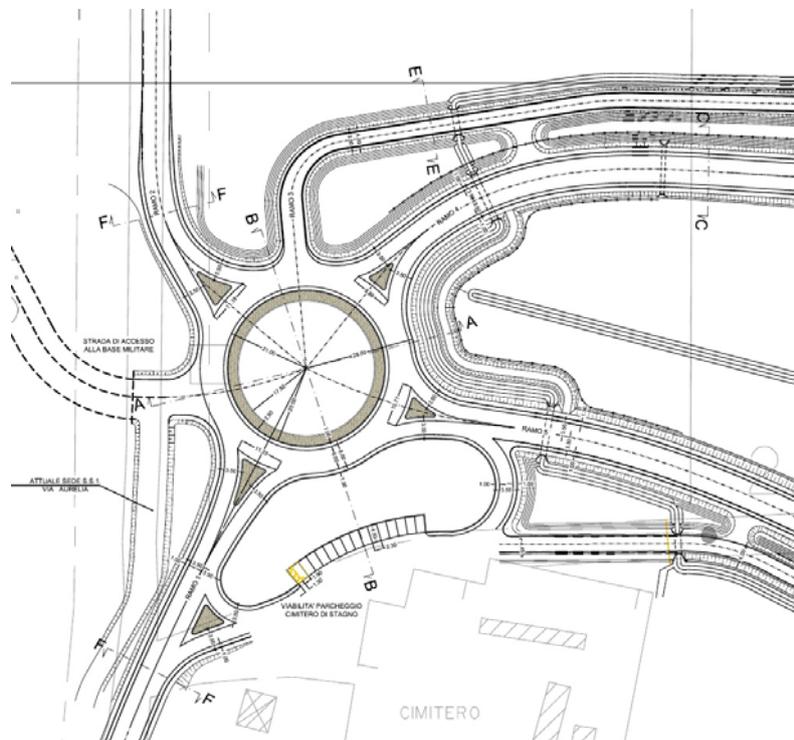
Planimetria di progetto – Particolare parcheggio cimitero
